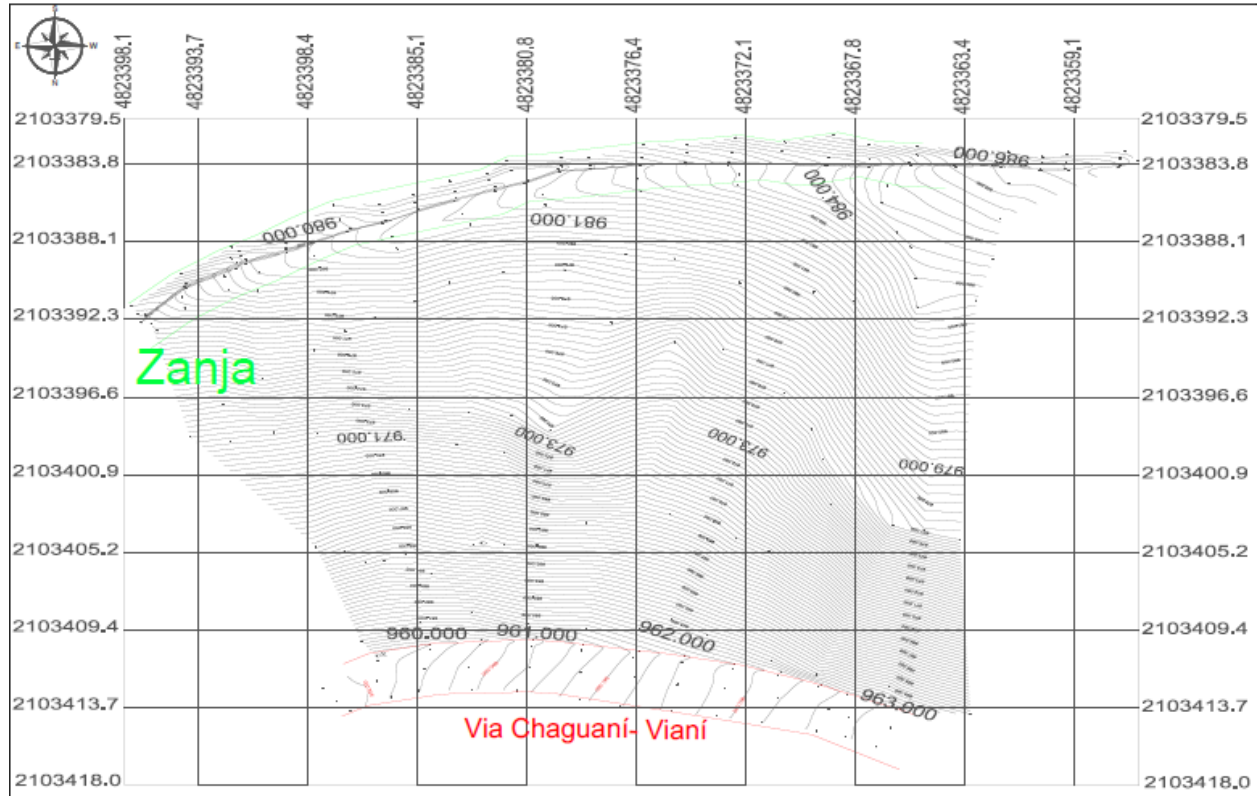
Topografía de la zona vista en planta. Fuente: Propia
